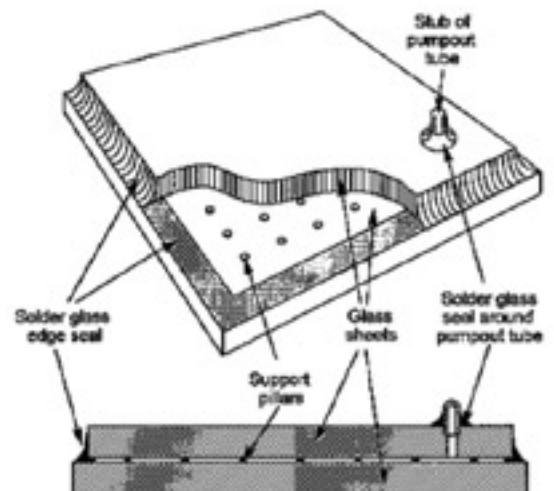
als auch privaten und öffentlichen Gebäuden eingesetzt werden, z. B. bei Fenstern, Fassaden und Überdachungen
